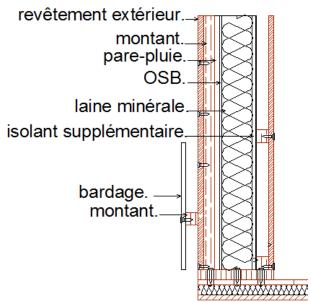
coupe détail fixation bardage bois. Source : auteurs.
